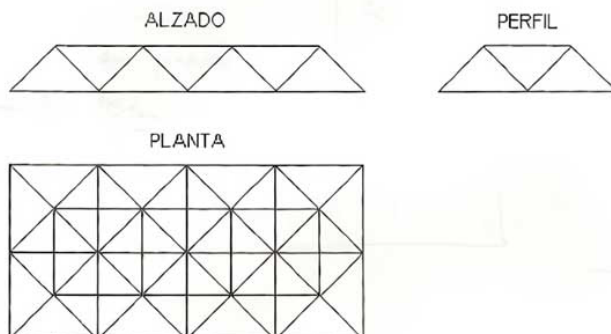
Vistas en sistema diédrico de la estructura a construir.
